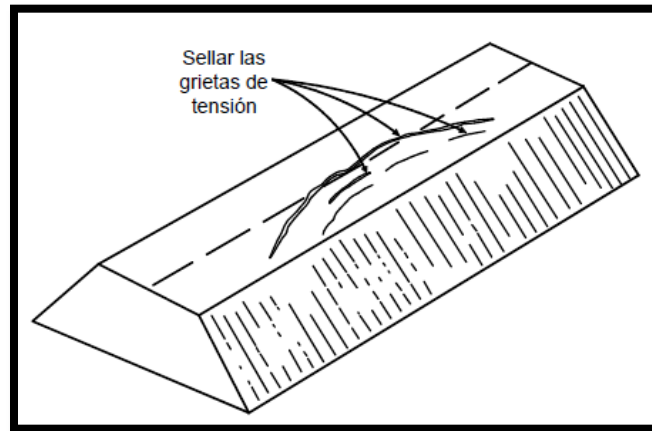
Se requiere sellar las grietas para impedir la infiltración que puede activar un deslizamiento.
